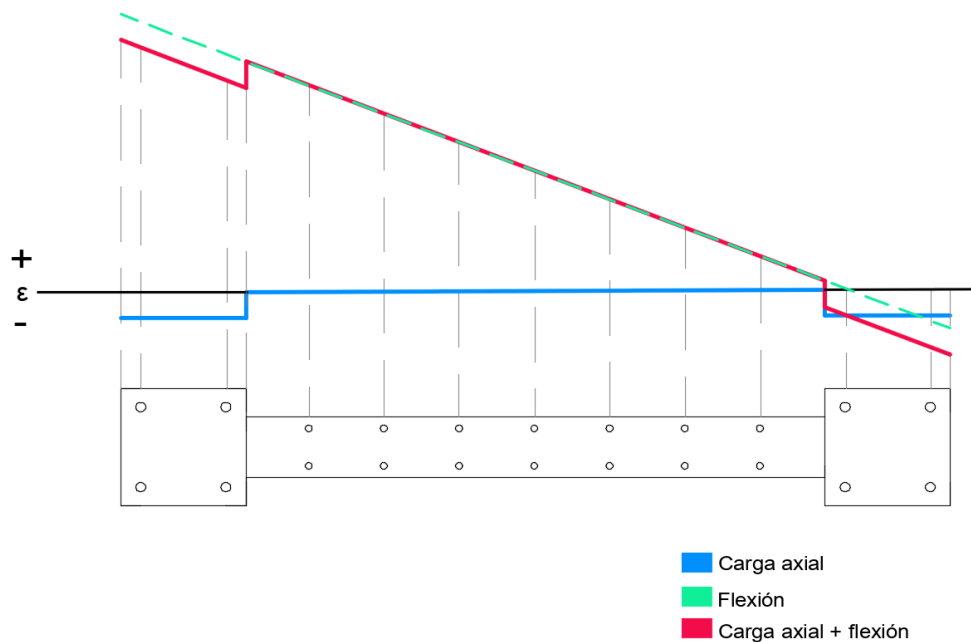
Distribución de las deformaciones unitarias en la sección transversal del marco reforzado con un muro nuevo de concreto bajo el efecto de las cargas gravitacionales y las cargas laterales
